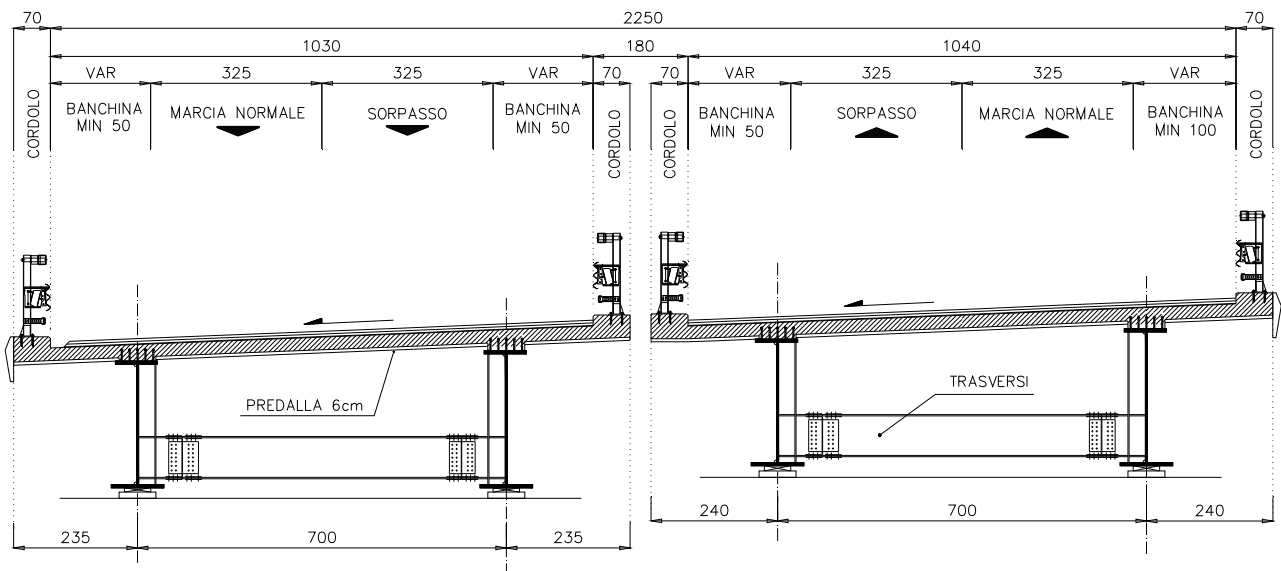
Sezione tipo impalcato Viadotto Cornia Vecchia 1
